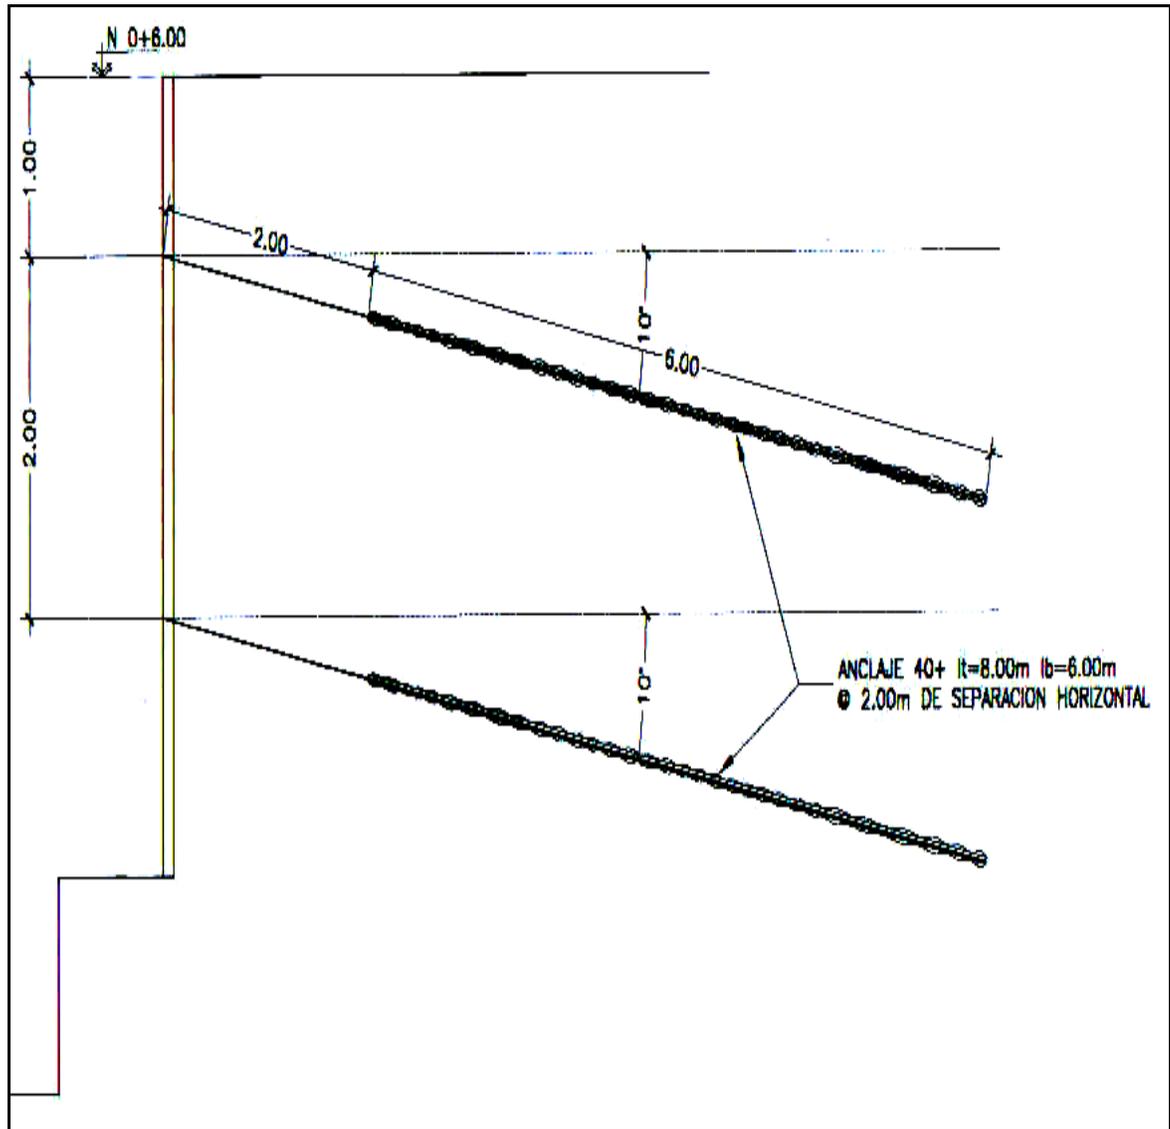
Distribución de anclajes tipo DRILL' O FAST²
